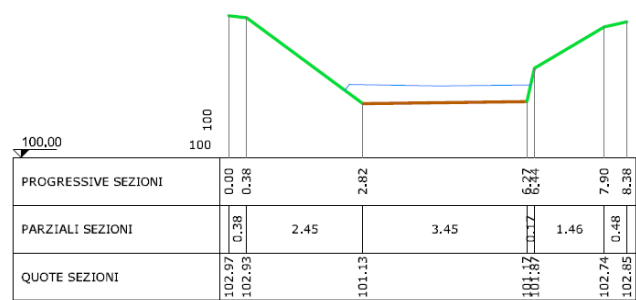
Sezione trasversale T1153 – COLO28 – 647
